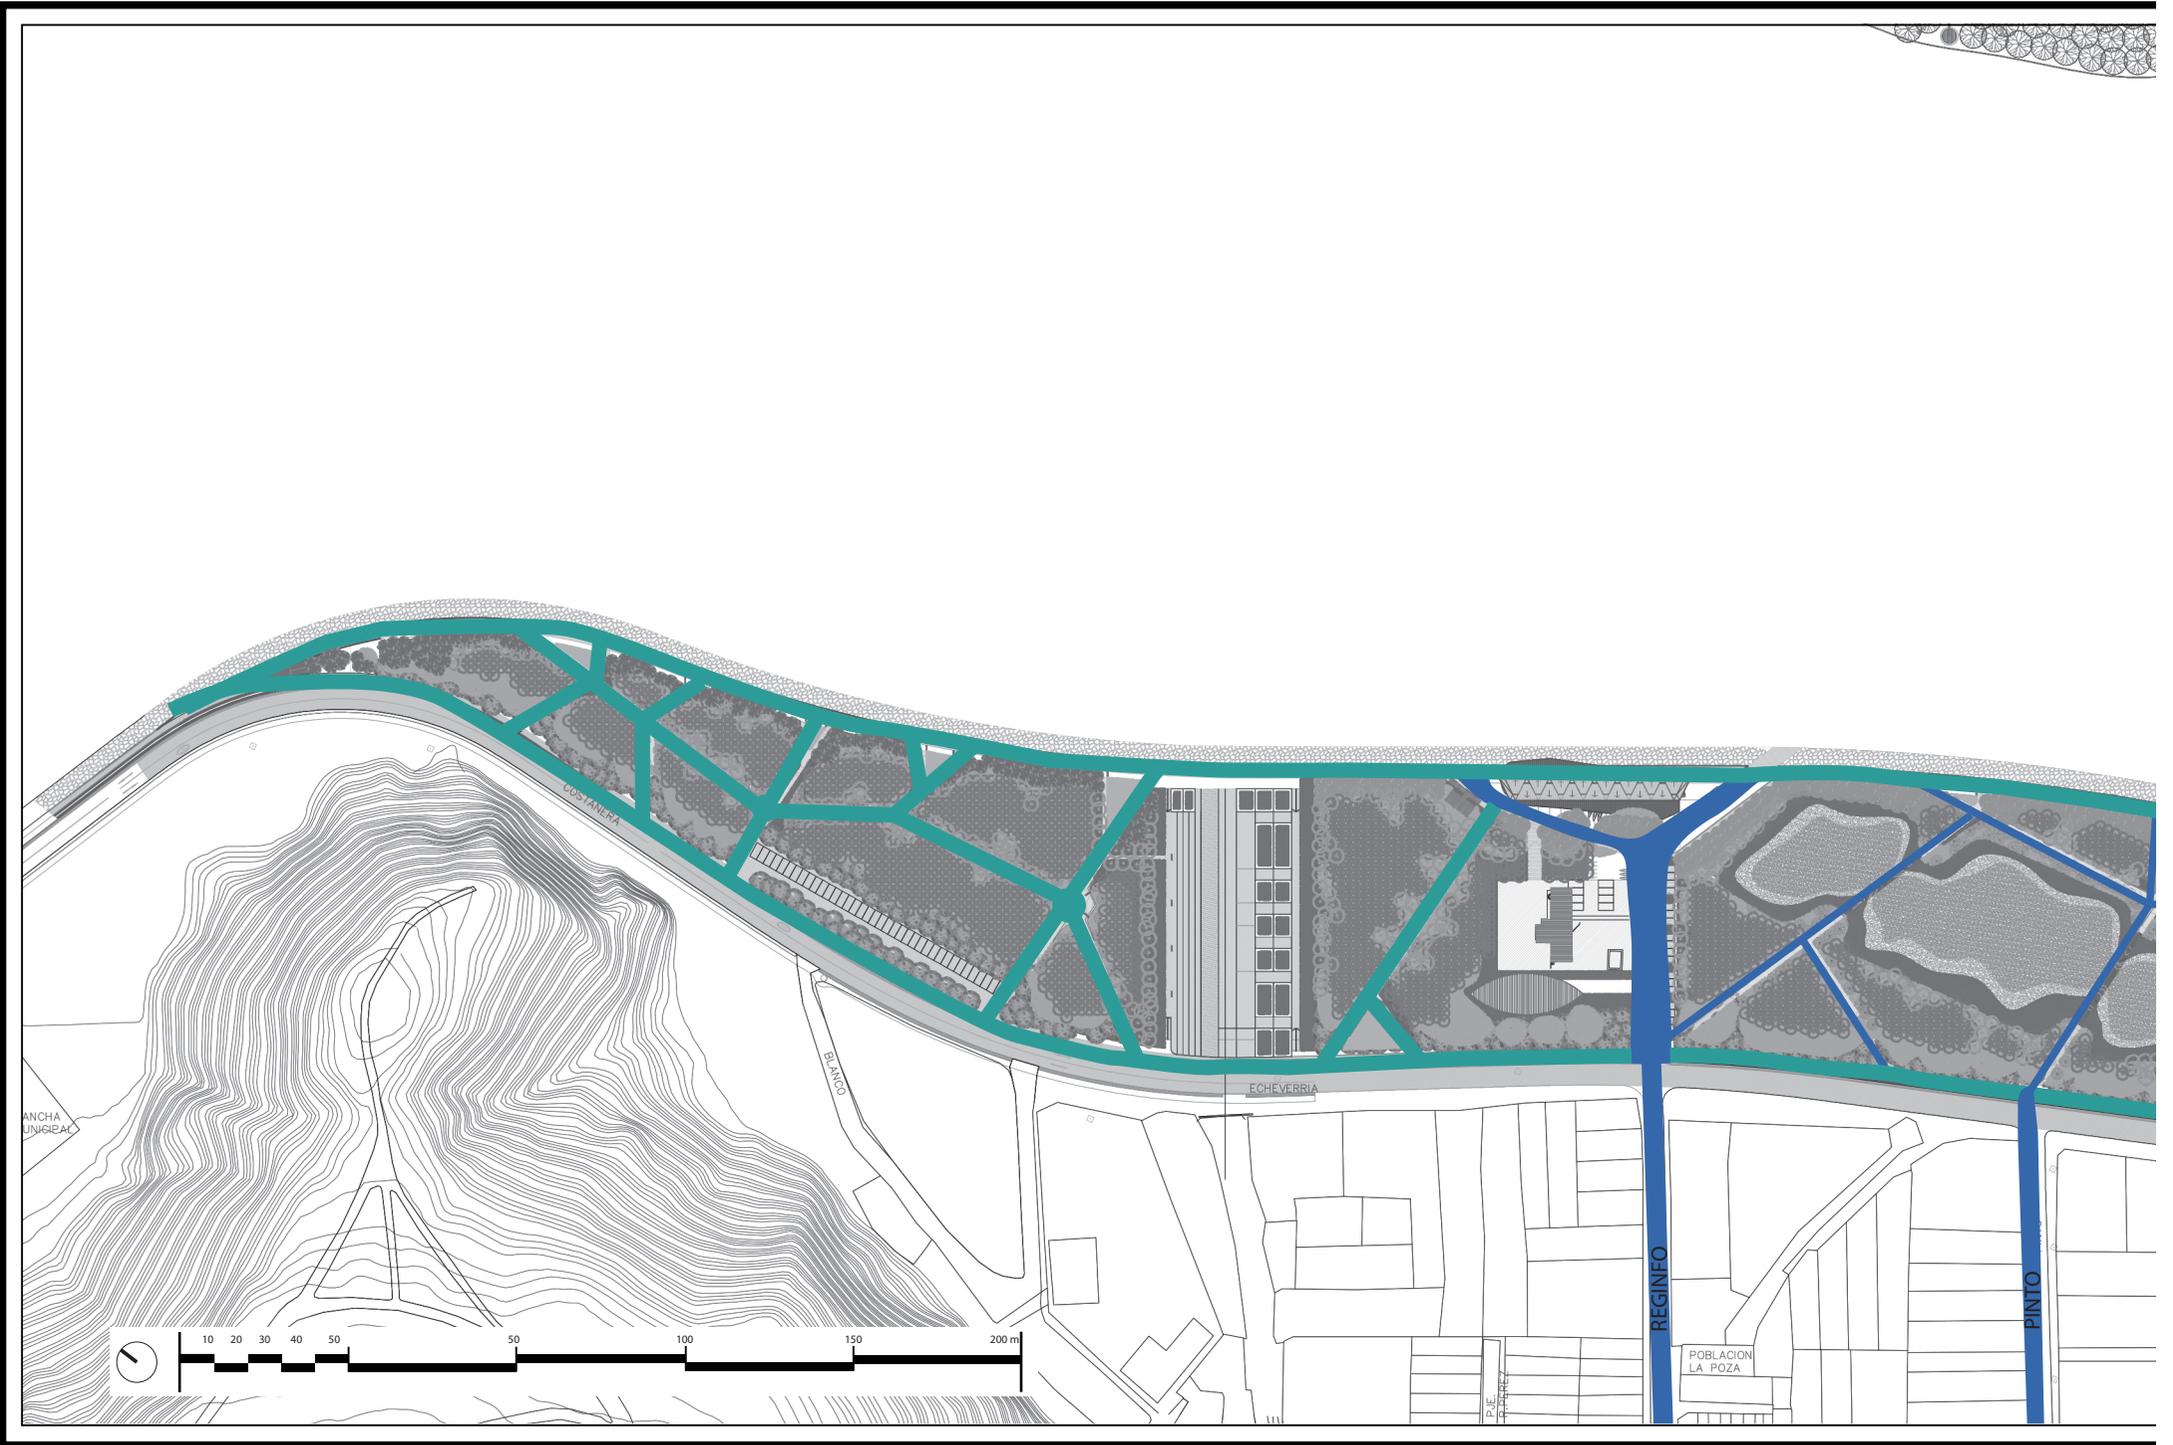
PLANIMETRÍA BARRERAS Y ESPECIES DE VEGETACIÓN
